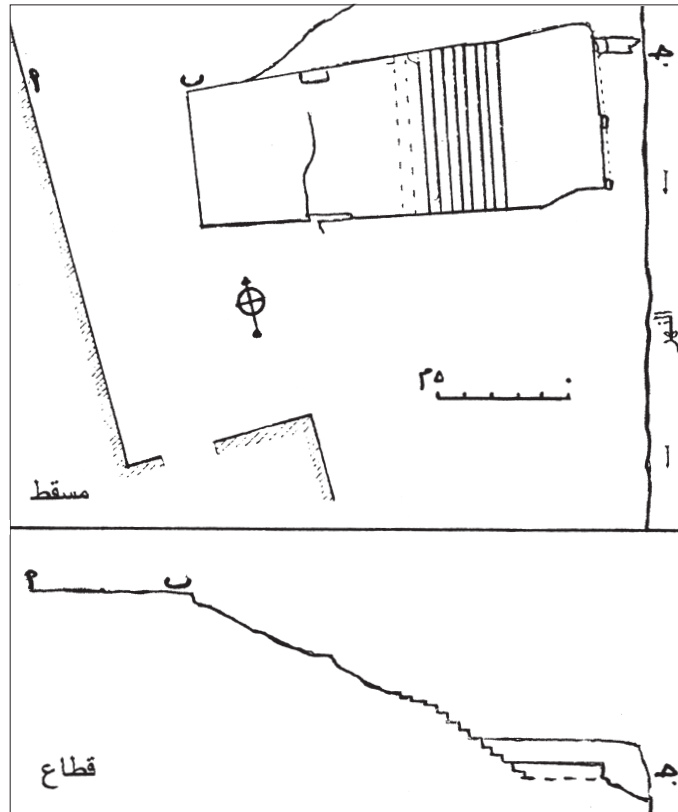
لبلة. باب النجدة، مسقط أفقي. عن (Maldonado).
